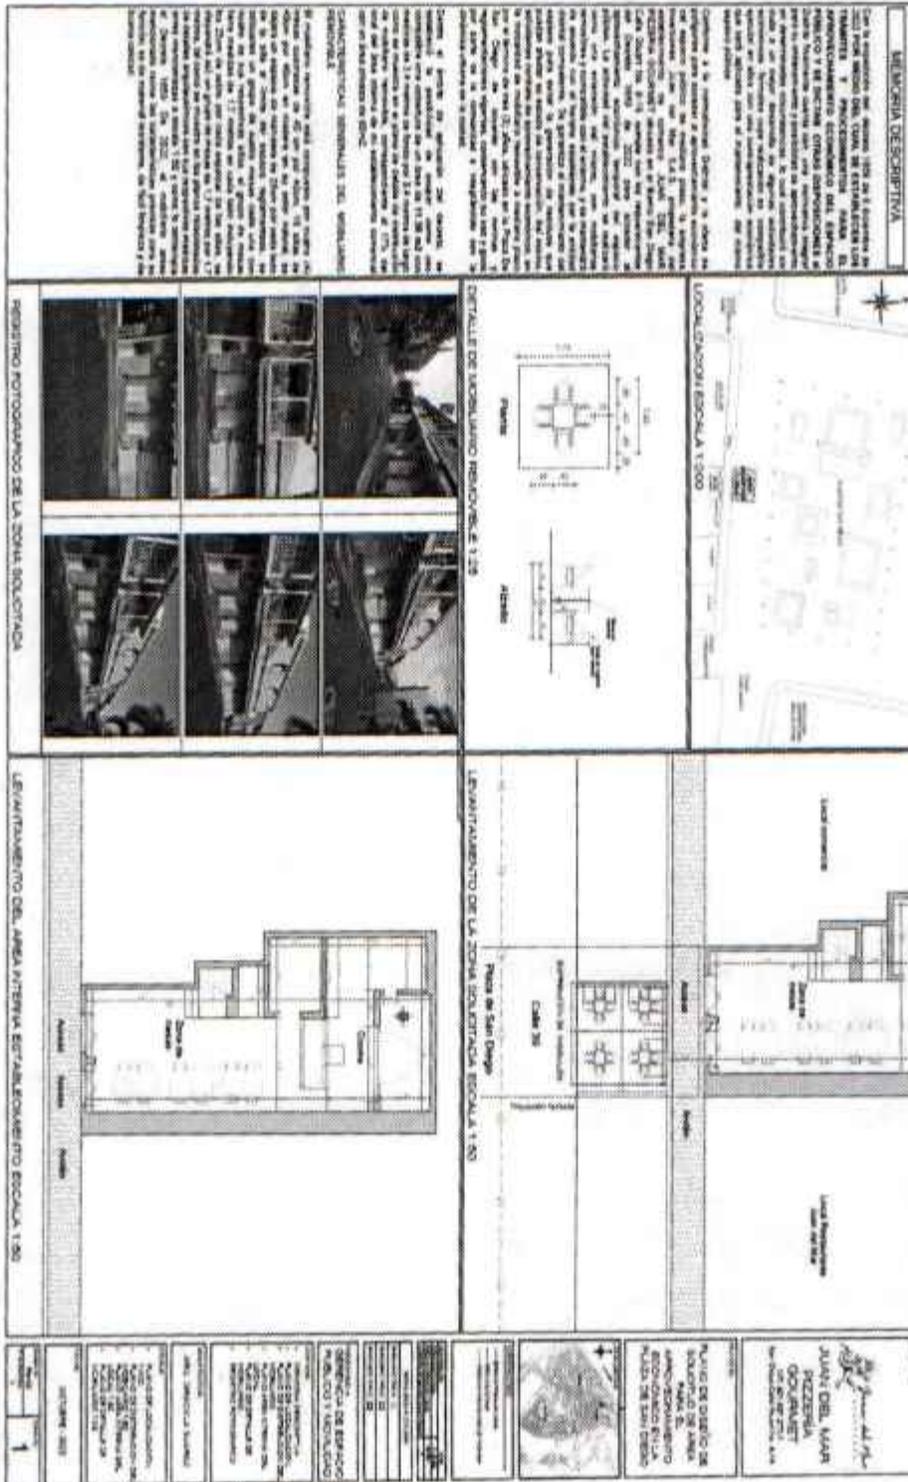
Plano JUAN DEL MAR PIZZERÍA
